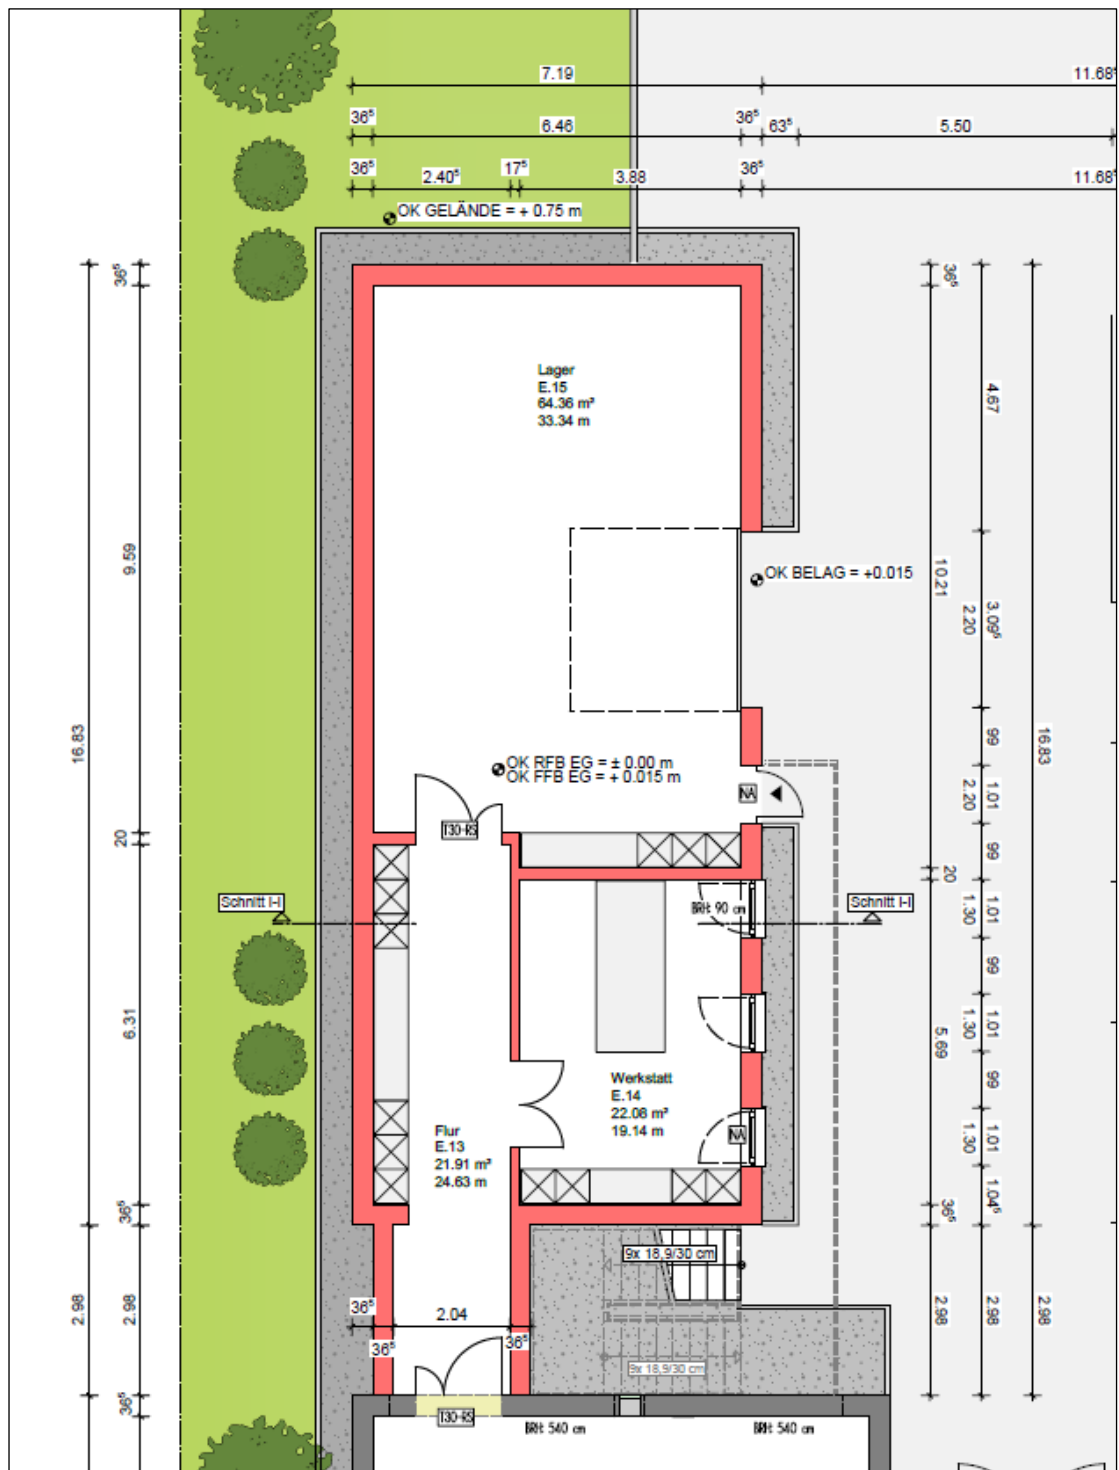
Grundriss des geplanten Anbaus, Erdgeschoss. David Kölsch, freier Architekt, 04.03.2023
